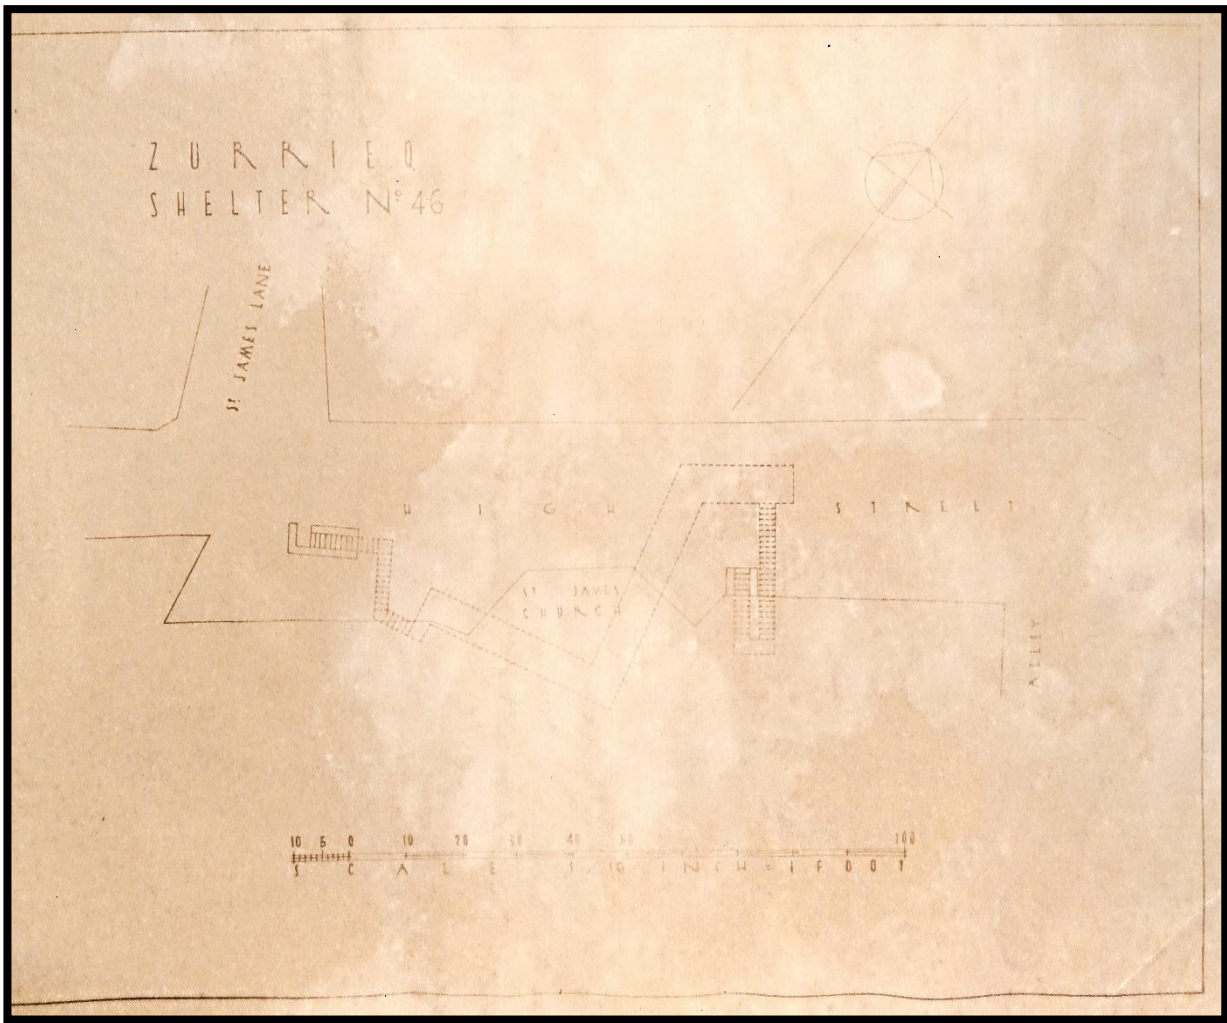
Planta do Abrigo nº46 "High Street – St. James Street."
